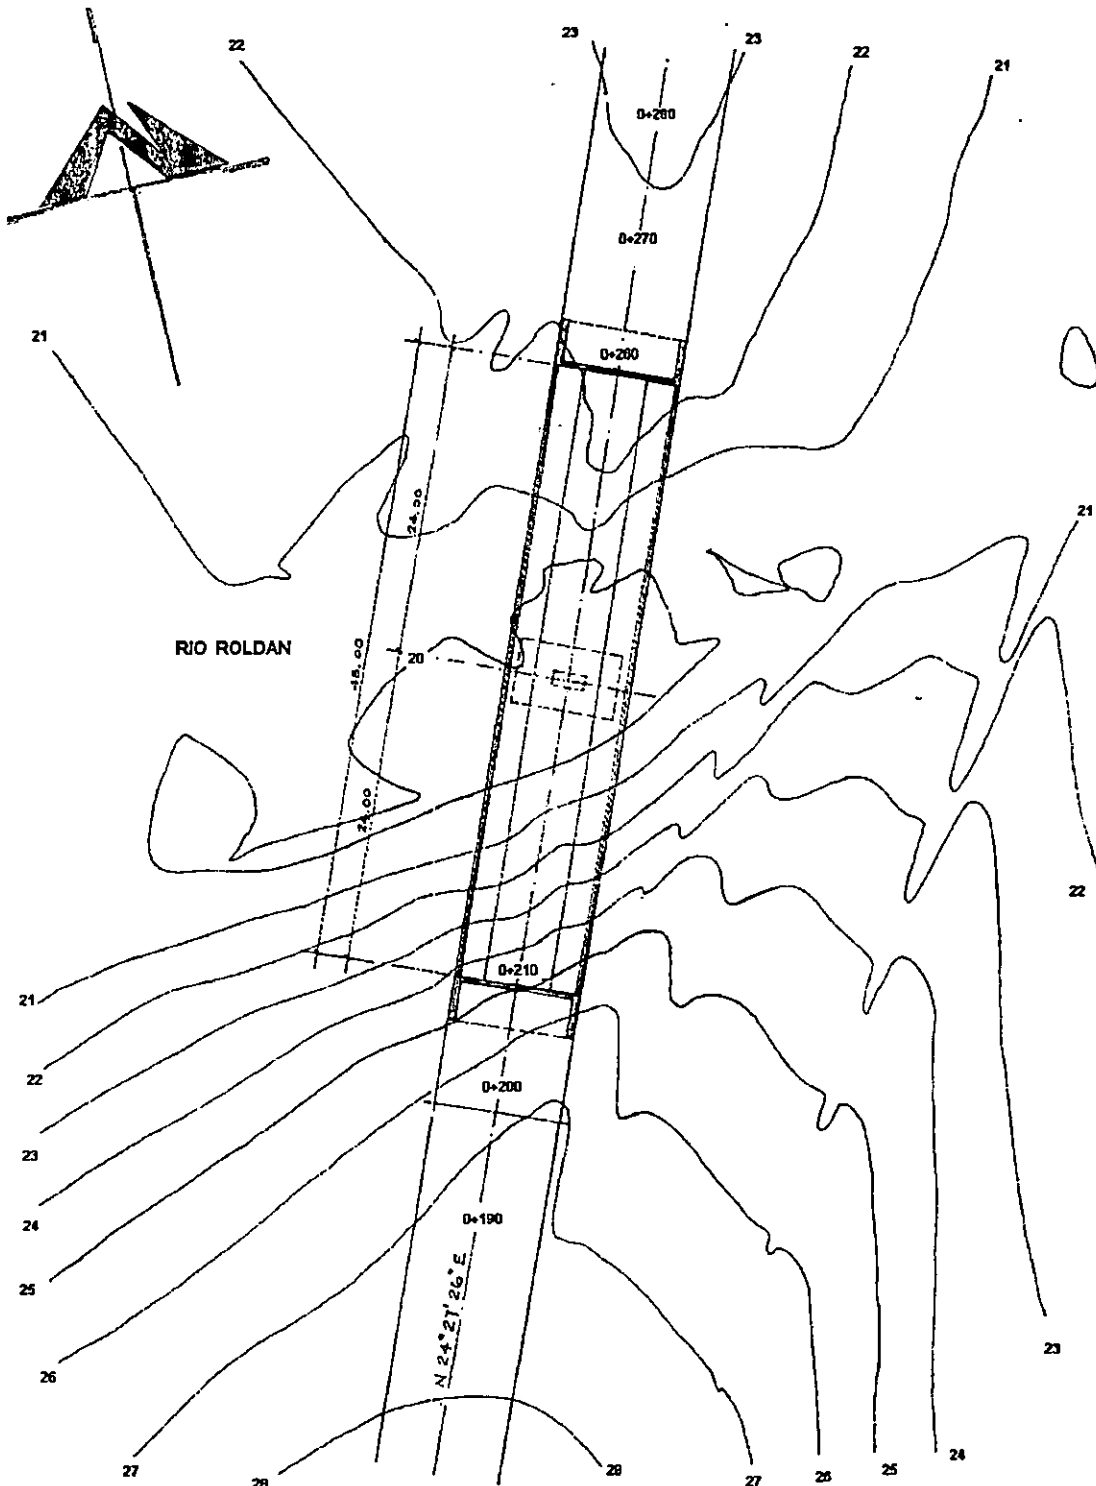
PLANTA DEL PUENTE SOBRE EL RIO ROLDAN.
